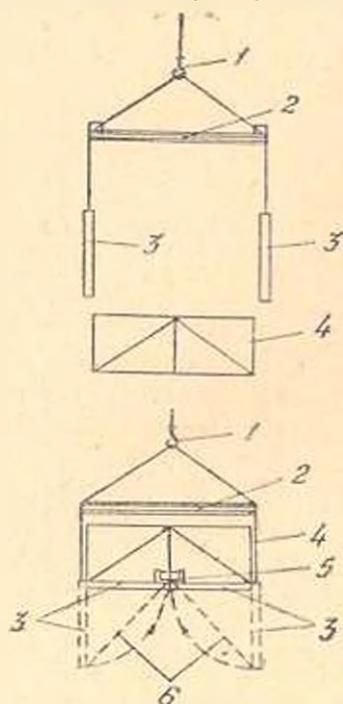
Схема подвески нижних щитов опалубки арки. 1—крюк кабельного крана; 2—траверса; 3—нижние щиты опалубки; 4—жесткий каркас арки; 5—лебедка; 6—капаты для подтягивания щитов.
